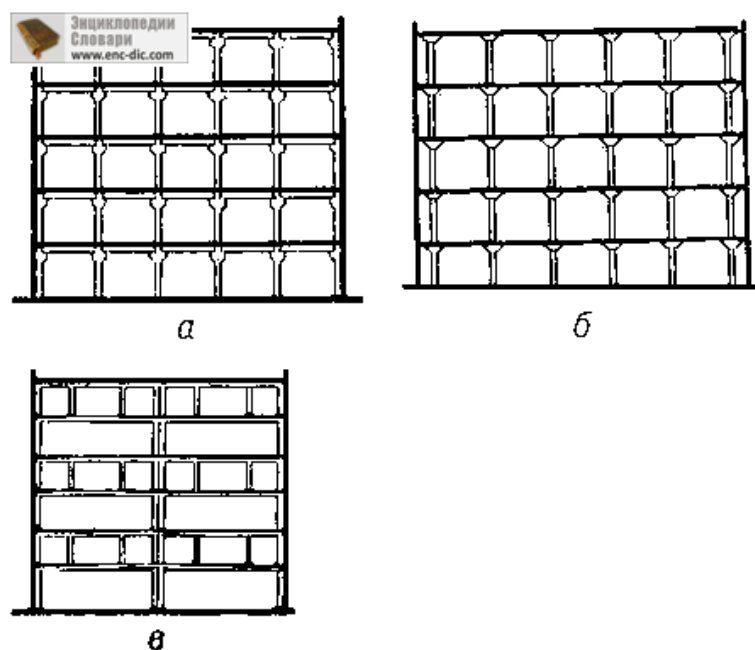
Многоэтажные промышленные здания: а — с балочными междуэтажными перекрытиями; б — с безбалочными междуэтажными перекрытиями; в — с техническими межферменными этажами.
